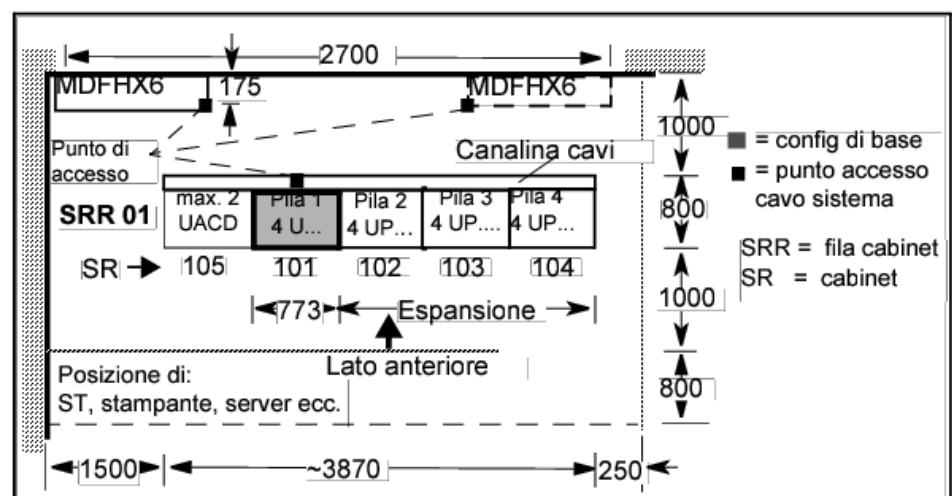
Installazione a pavimento OpenScape 4000 (variante da 30")
